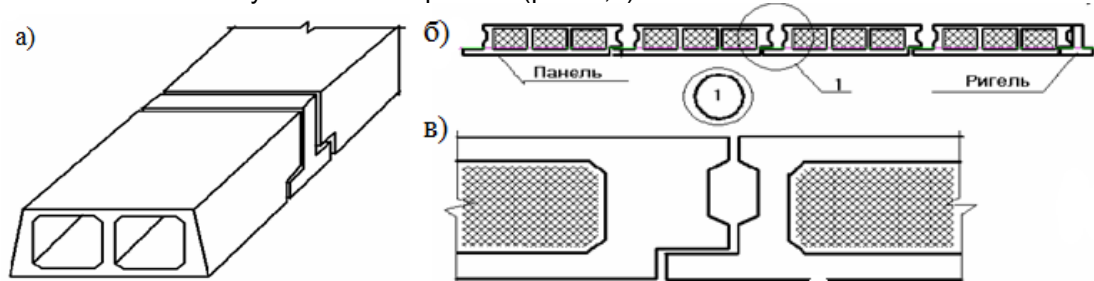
Схема перекрытия з гладкою стелею (а); ячіяка перекрытия системи «ІКАР» (б); вузол стику панелей системи «ІКАР» (в)
